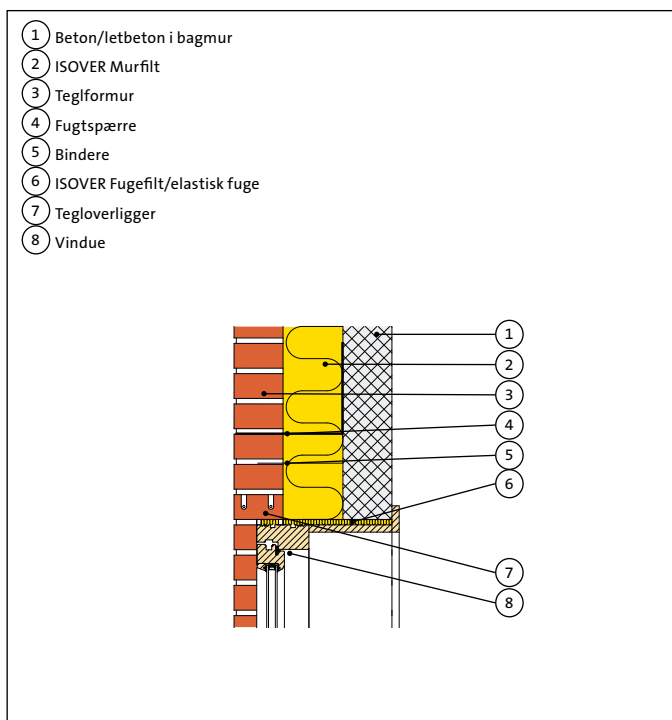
Tegloverligger og bagmur i beton/letbeton – lysning i plademateriale.
